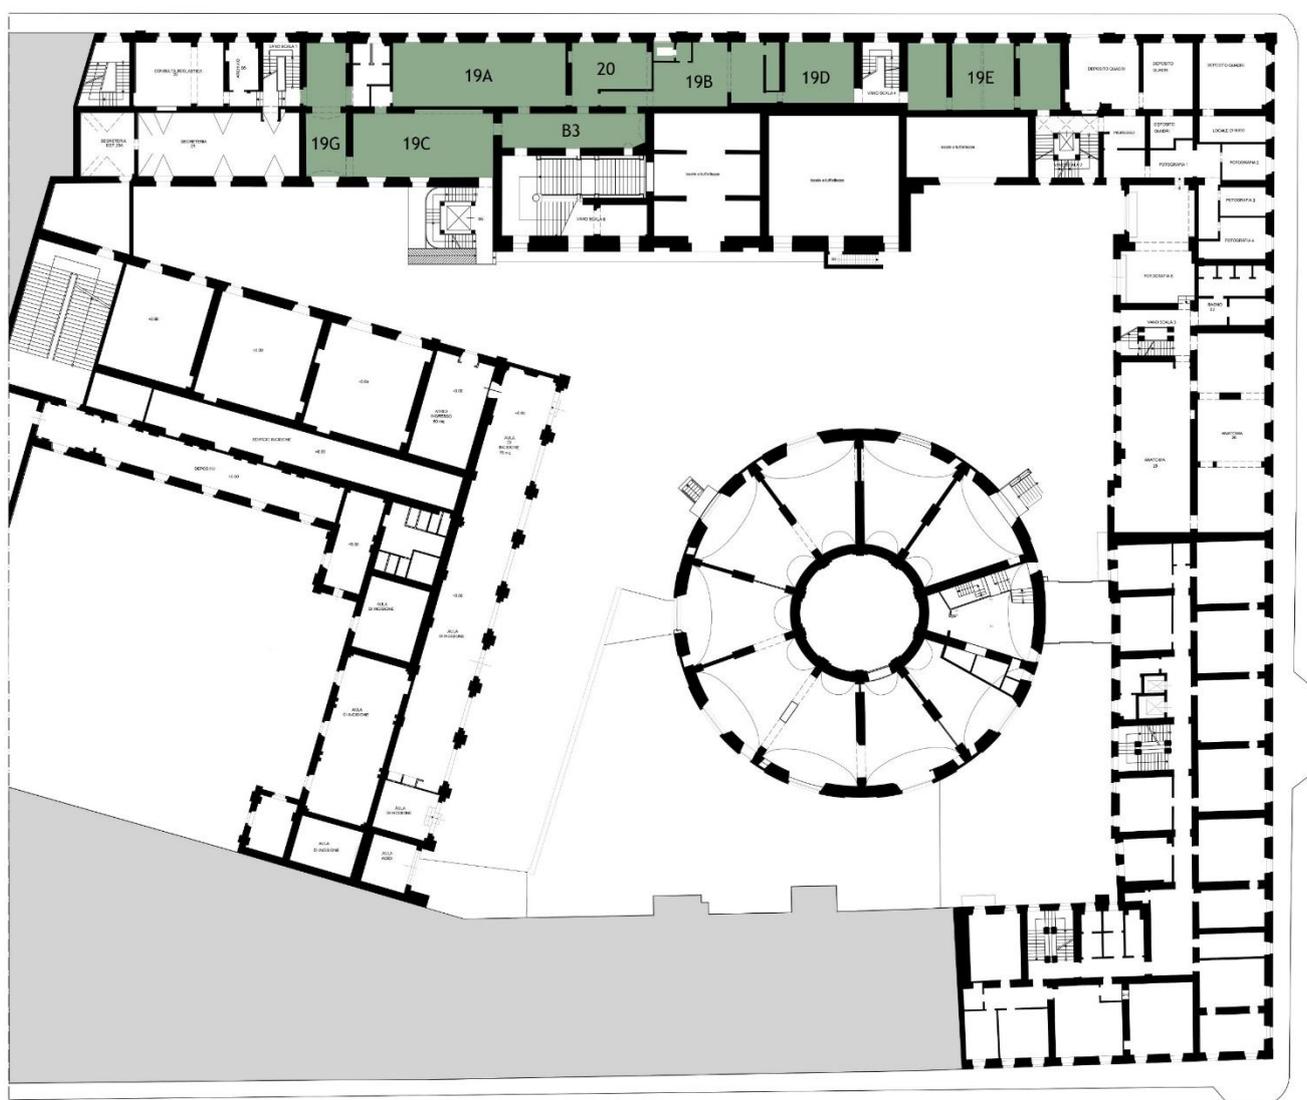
Pianta dello stato di fatto con l'individuazione della biblioteca, primo piano.
